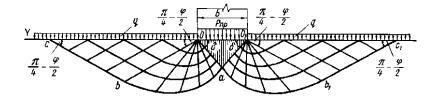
Сеть линий скольжения в грунте под жестким полосообразным фундаментом с учетом уплотненного ядра
